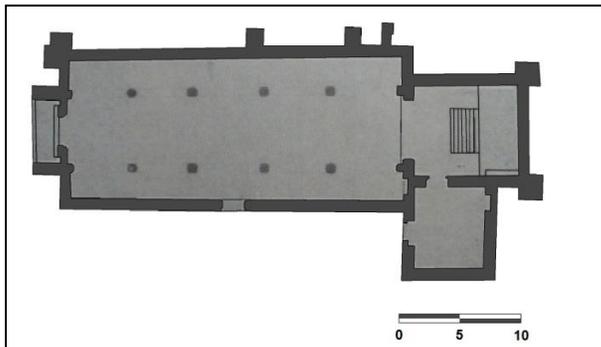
Planta Arquitectónica de la Iglesia de la Merced, León Viejo.
